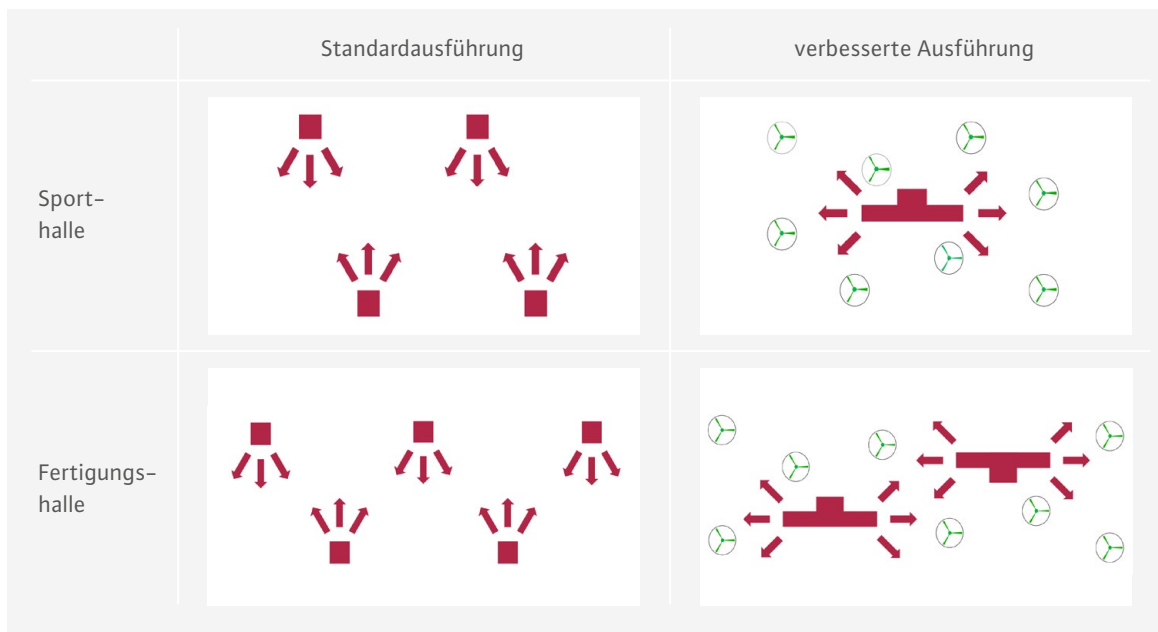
Hallengrundriss mit Heizgeräten und ggf. Ventilatoren, vereinfacht
